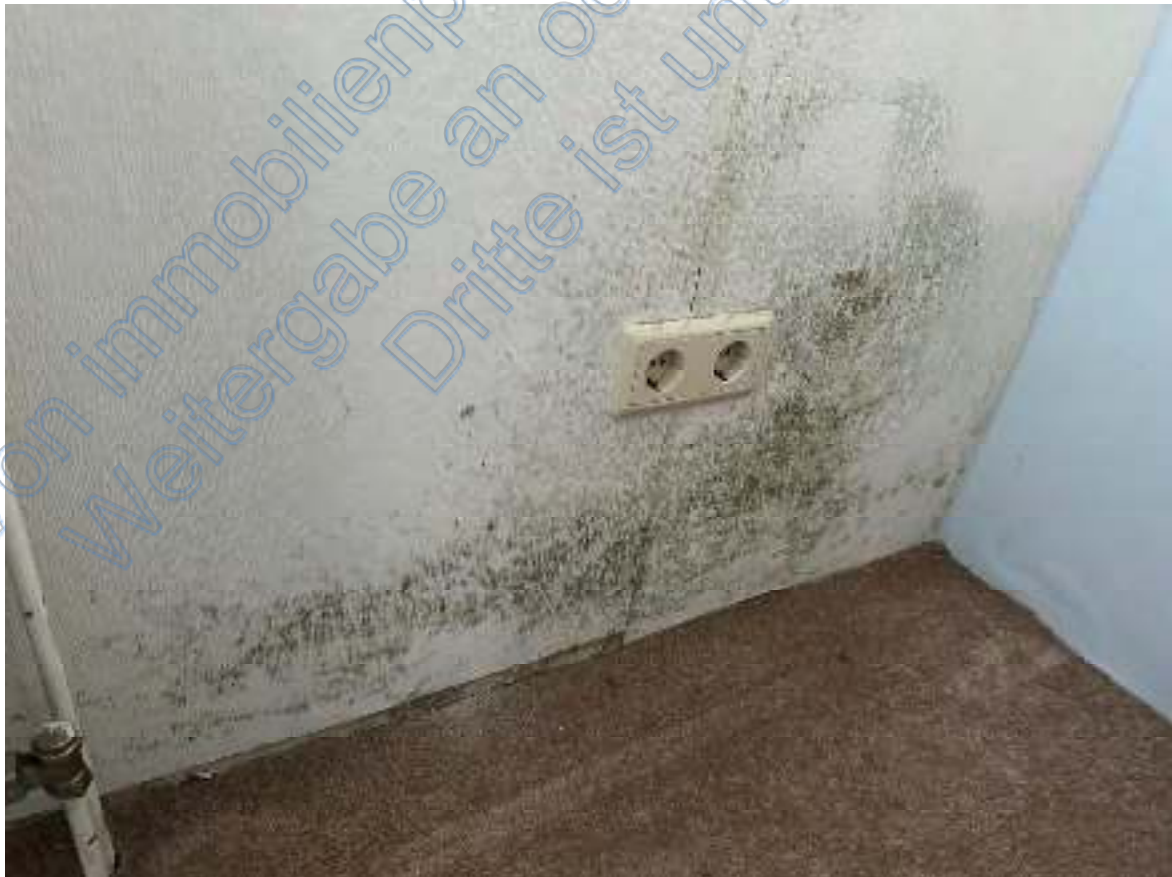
Ausschnitt – „erhebliche“ Durchfeuchtung der Außenwand mit Schimmelbildung im Zimmer 1
